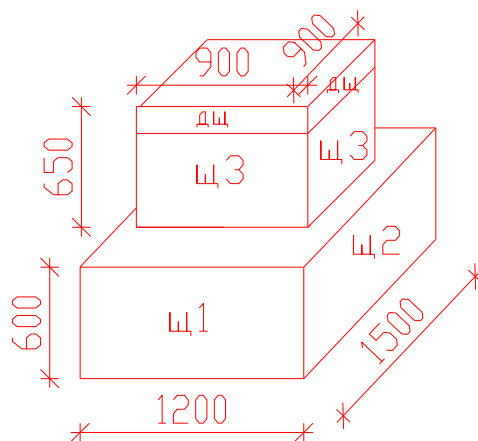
Схема розкладки щитів стовпчастого фундаменту
